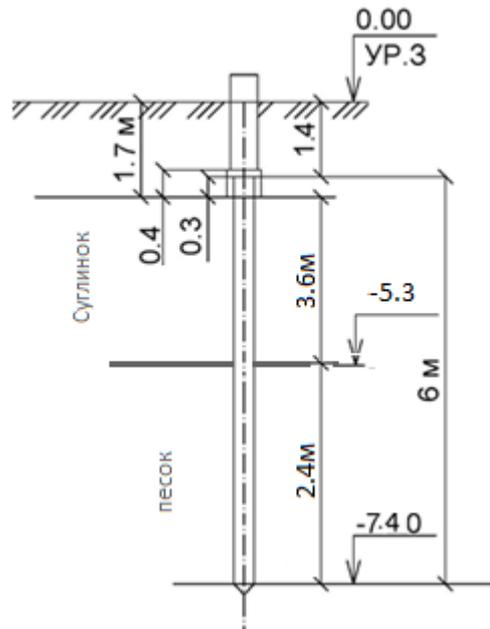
Схема размещения сваи-стойки в грунтах основания
